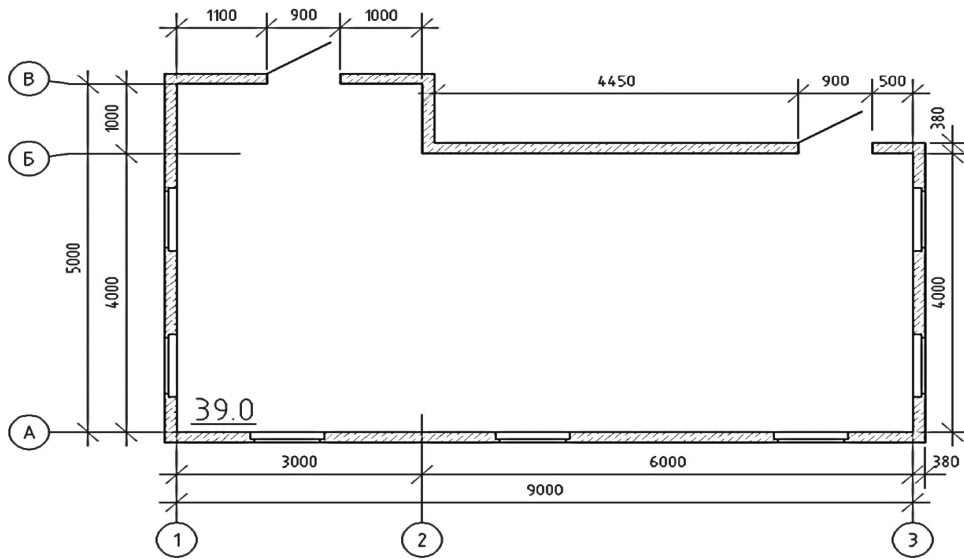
План этажа рассматриваемого помещения для проведения анализа
